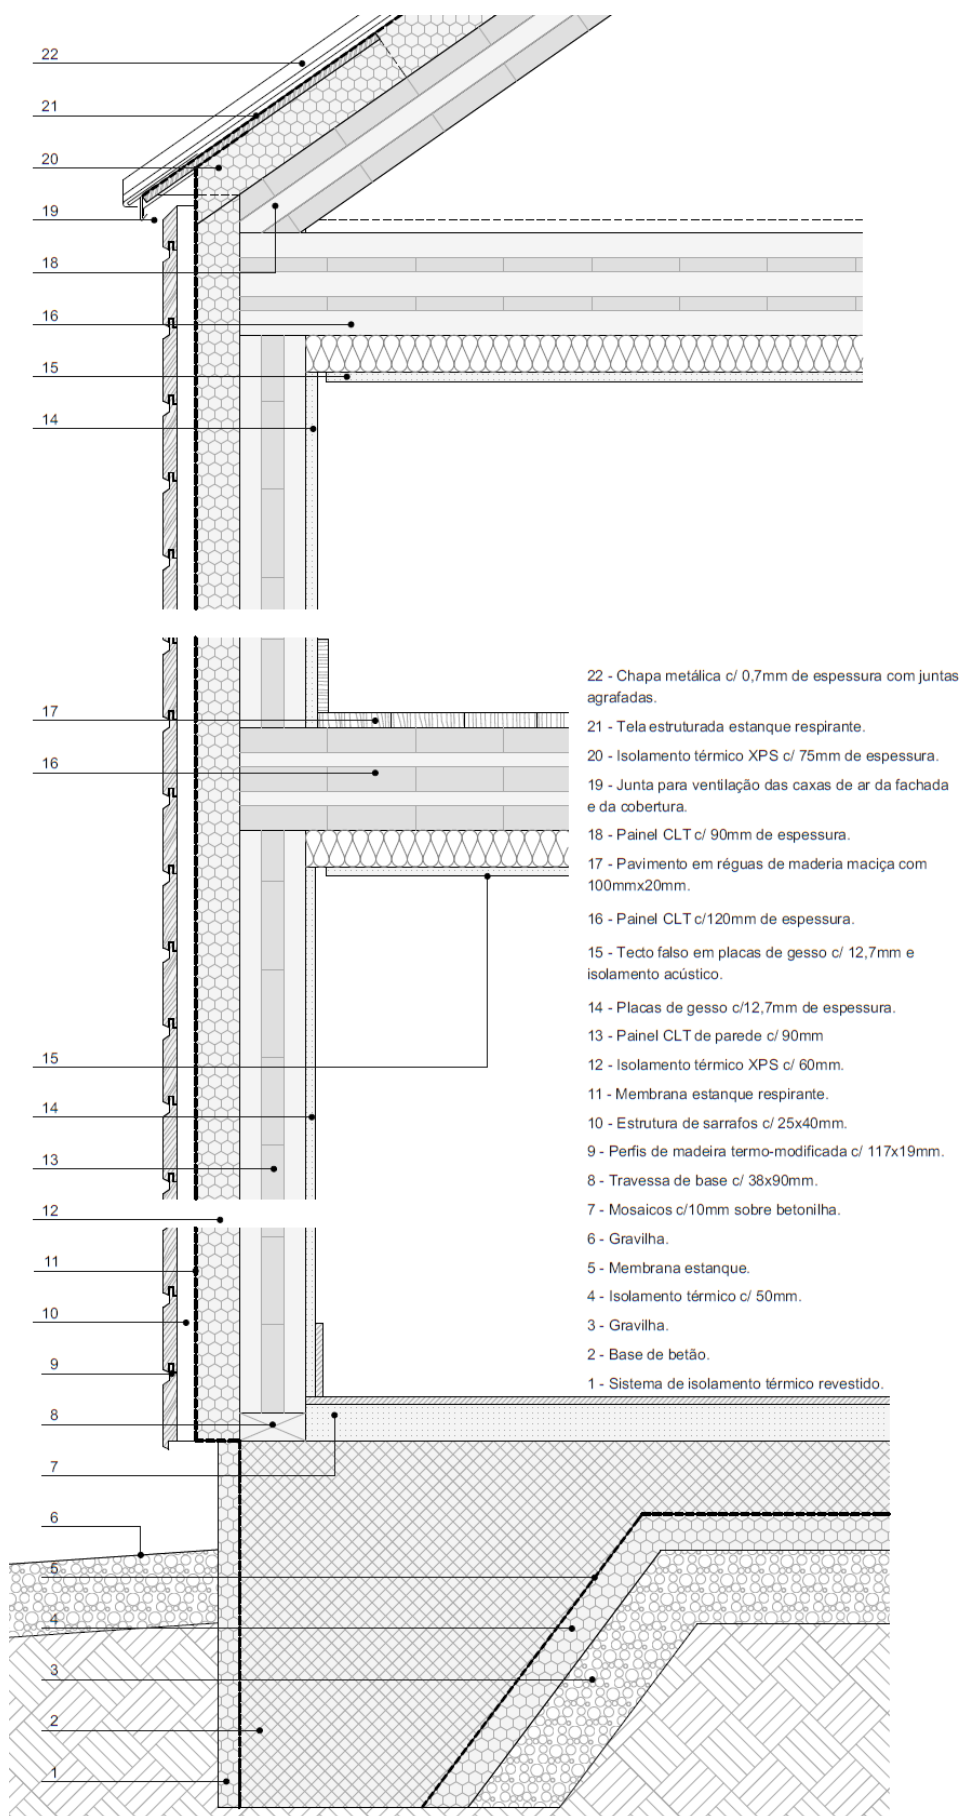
Corte construtivo pela fachada da solução com painéis pesados lamelados colados.
